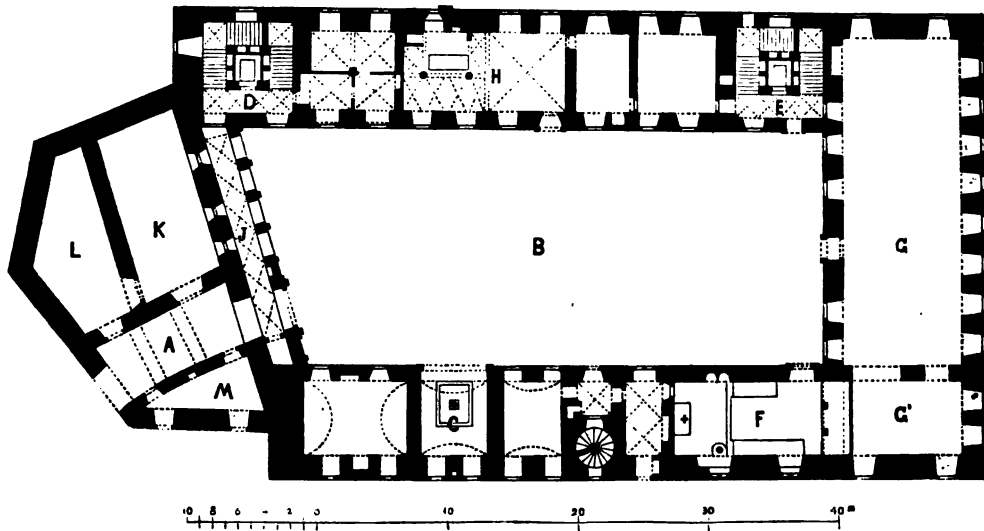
Schloß zu Heiligenberg. Grundriß des Erdgeschosses.
